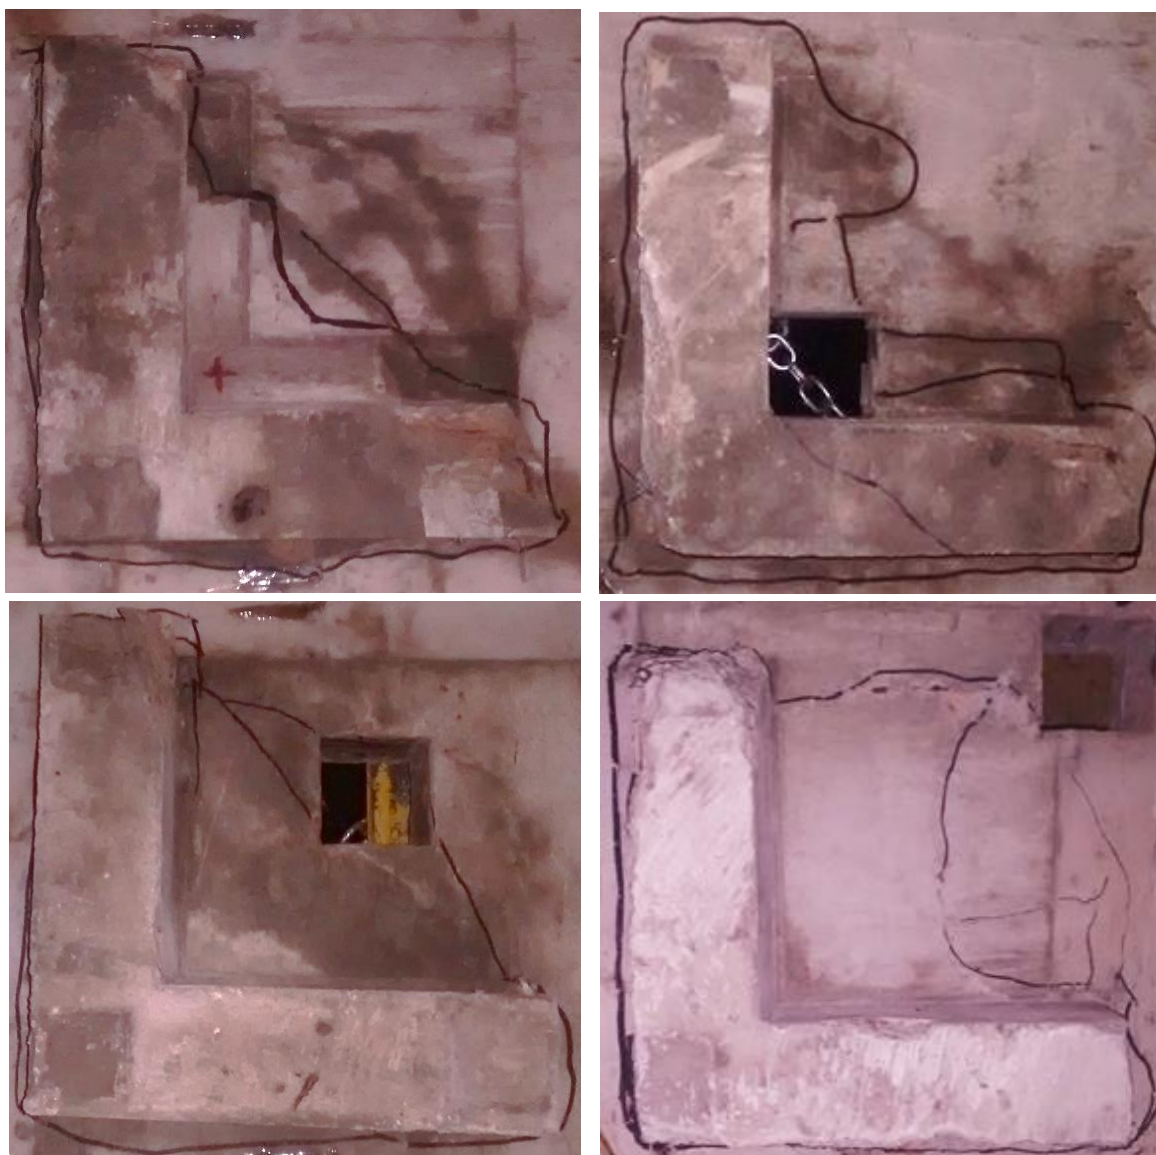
Superfície de ruptura na base das lajes ensaiadas
